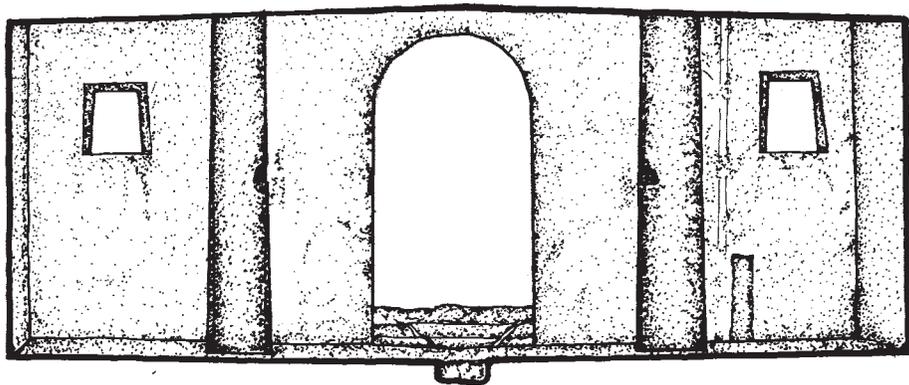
5. *Andrea Priu. Aula. Sezione (Architetti Crescenzi e Scalzo).
